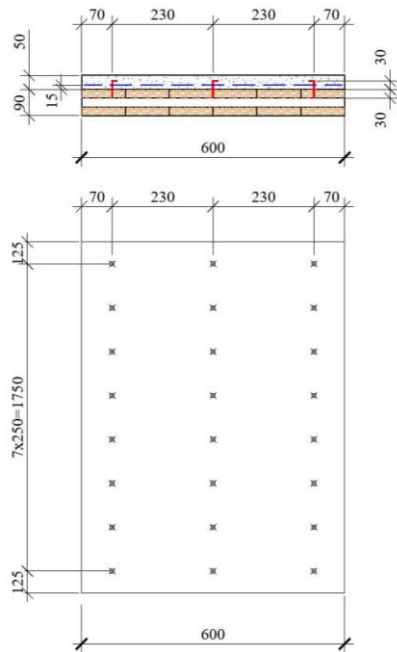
Загальна схема деревозалізобетонної панелі перекриття для експериментальних досліджень
